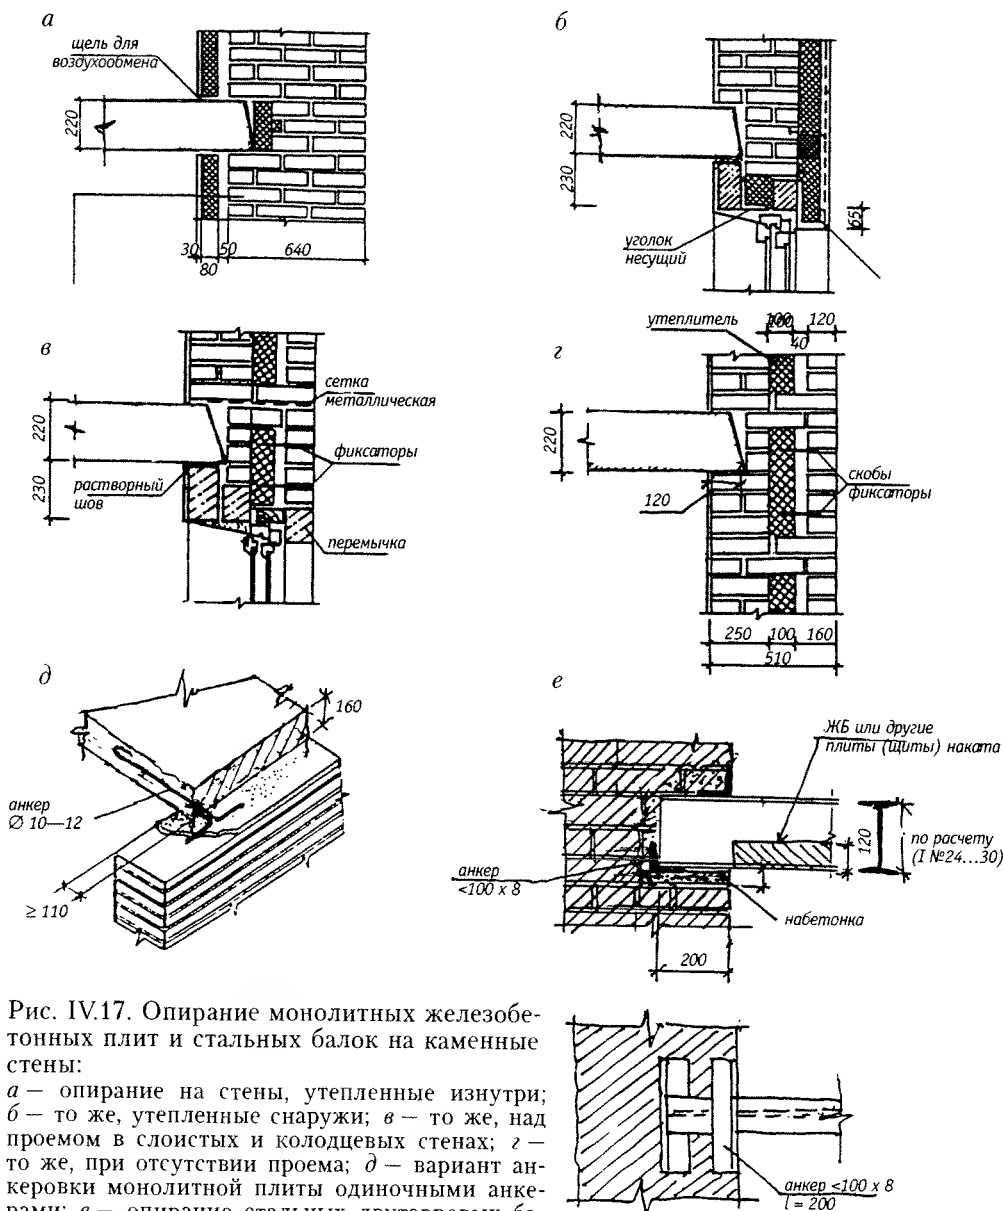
Опи́рание монолитных железобетонных плит и стальных балок на каменные стены:
